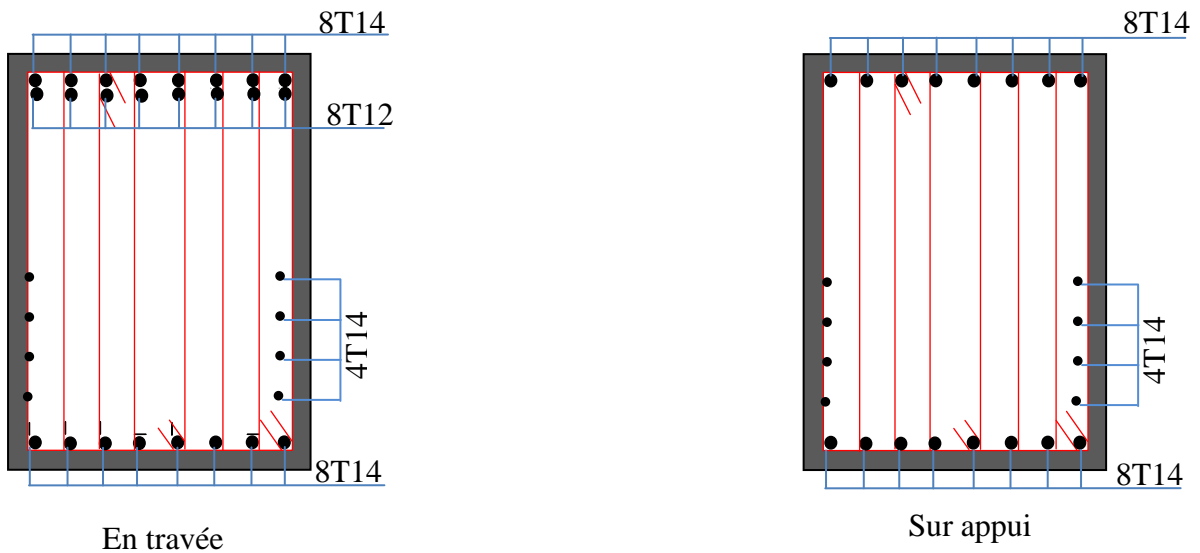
schéma de ferrailage de la poutre de libage Sens transversal(x).
